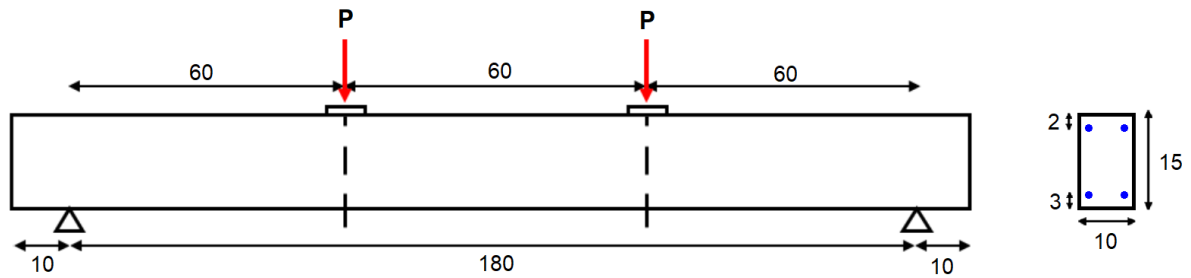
Configurações das vigas de Kovács e Balázs (2003) (medidas em cm).
